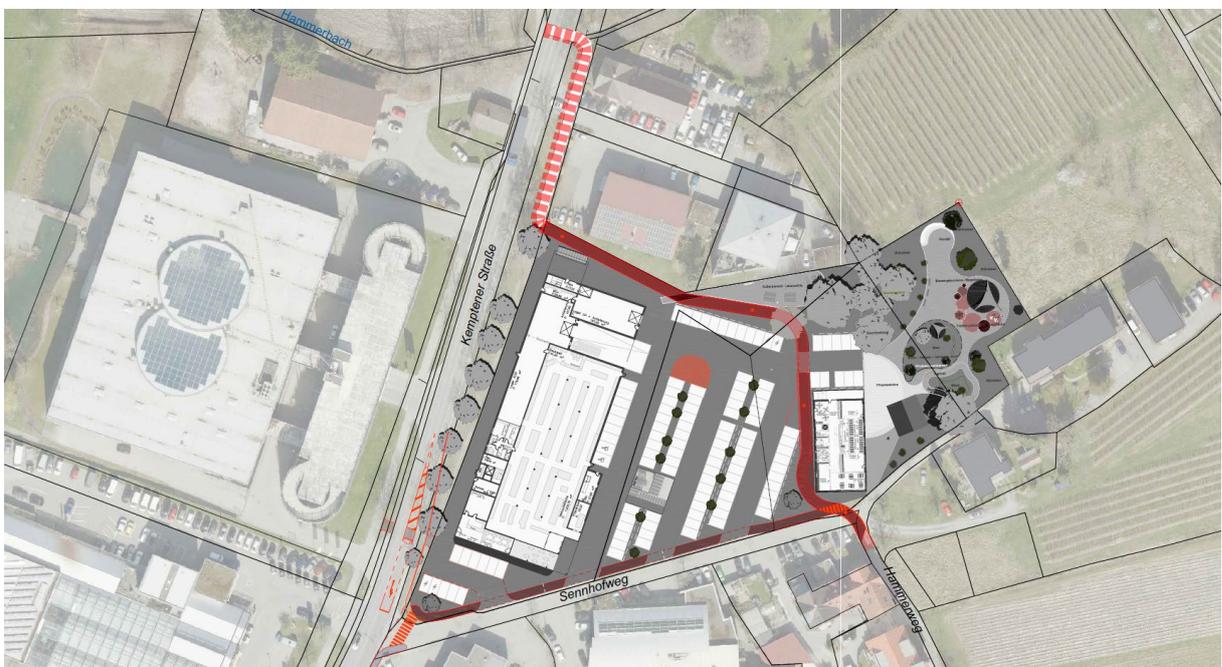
Übersichtslageplan Planungsperimeter, (Architektenplan/BuP)
